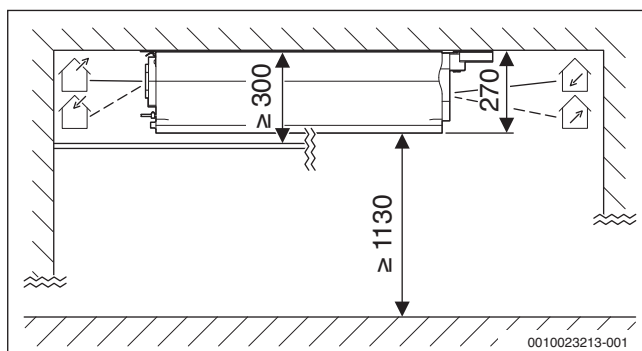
Dimensioni e distanze minime per l'installazione a soffitto di Logavent
